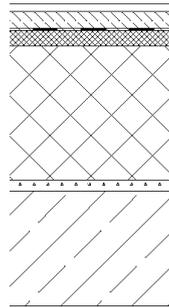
Ausführung unterste Geschosdecke, 'Utendorfsgasse' [Arch. DI Franz Kuzmich]
